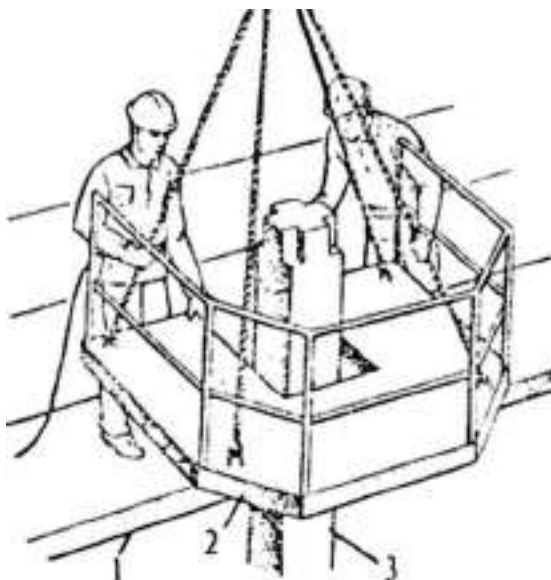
Установка монтажной площадки на колонну крайнего ряда:
